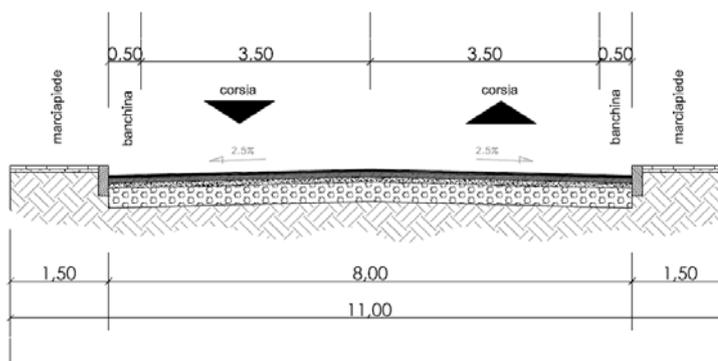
Sezione tipo strada a doppio senso di marcia
